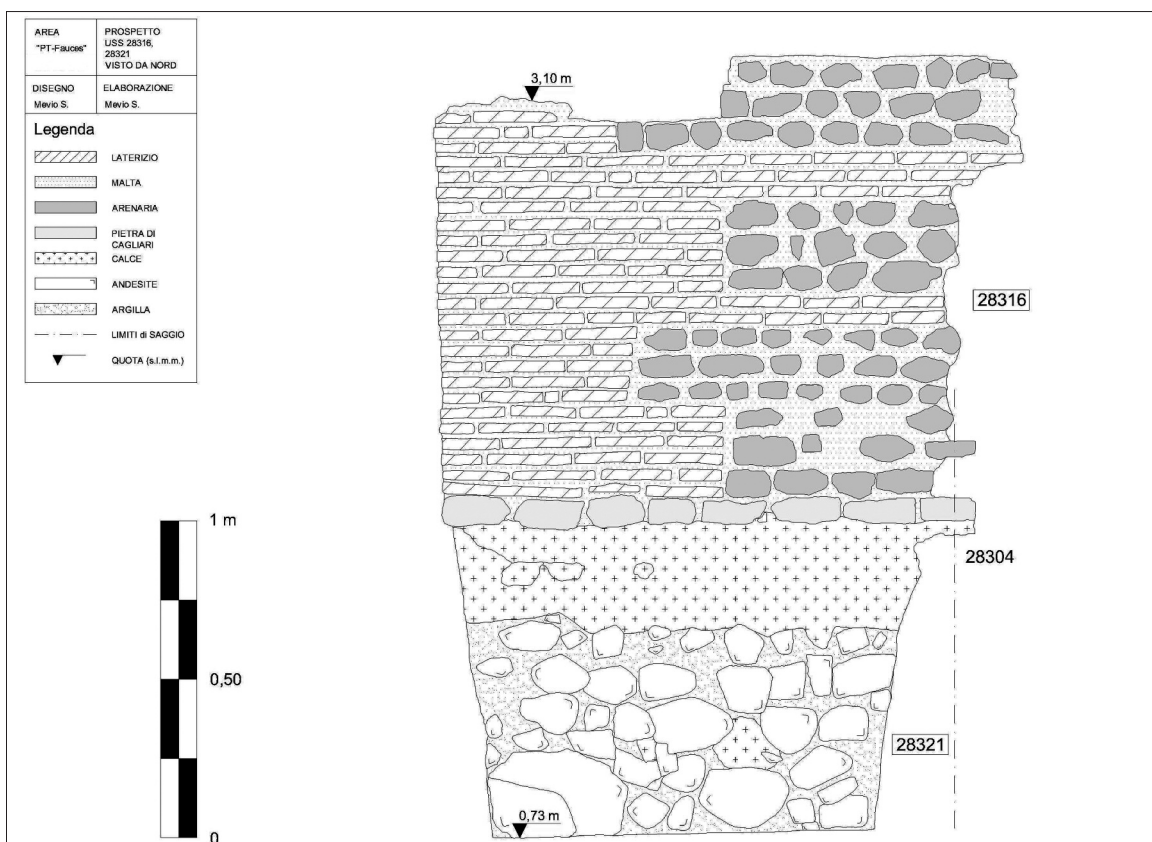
Prospetto delle strutture murarie USS 28316 e USS 28321, perimetrali settentrionali delle Piccole Terme.
